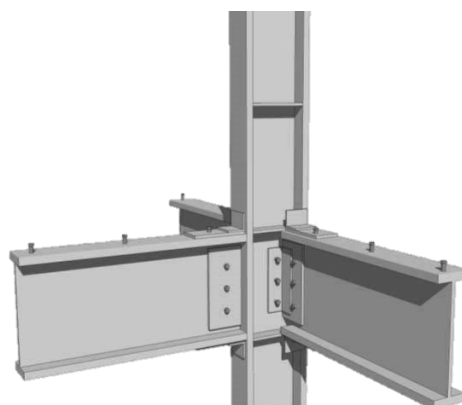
Detalles de amarre en perfilaría IPS 500
